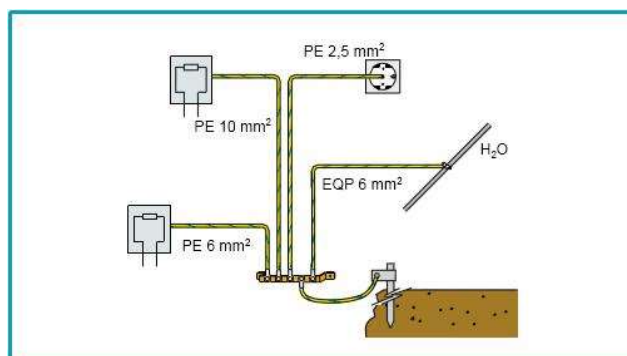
Schema distribuzione collettore e collegamenti equipotenziali
